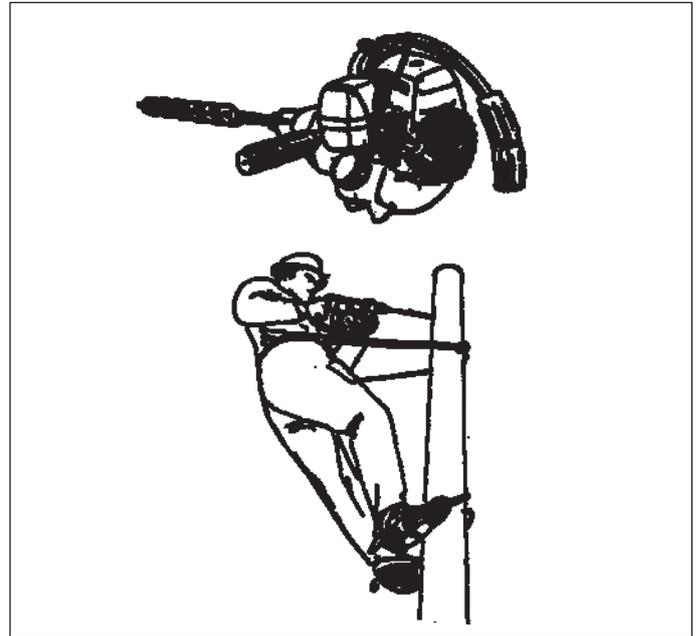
Сверлильная машина с двигателем внутреннего сгорания и высверливание отверстий в опоре.
